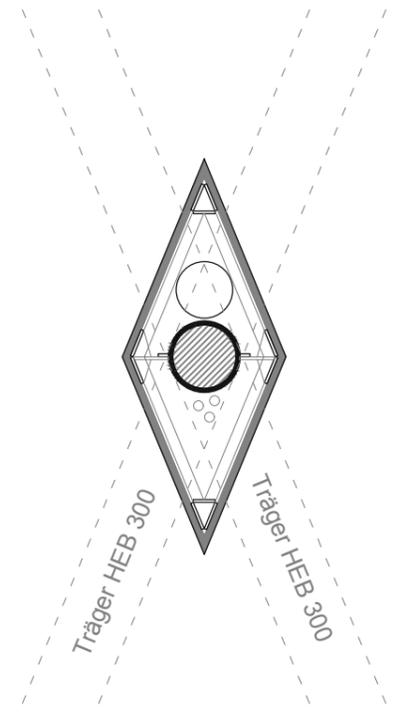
Grundrissdetail Stütze 1:20
